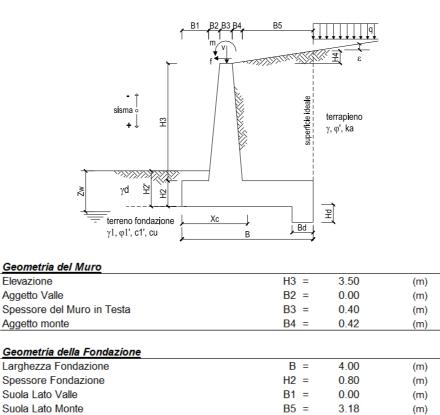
Caratteristiche geometriche muri di sostegno con fondazione diretta – tipo 2.
